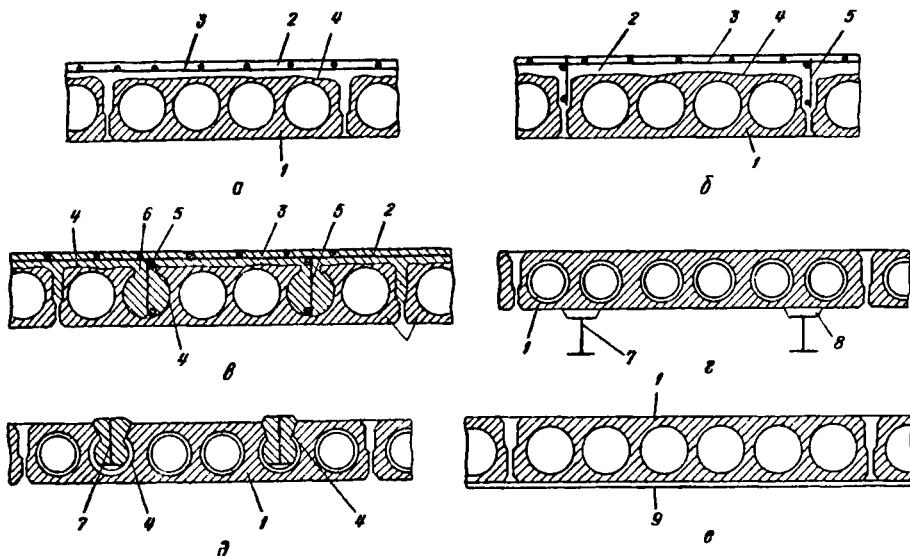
Підсилення перекриттів із плит з круглими порожнинами:
